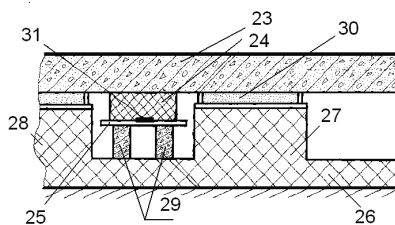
Схема виброизоляции железобетонной плиты в основании здания.
